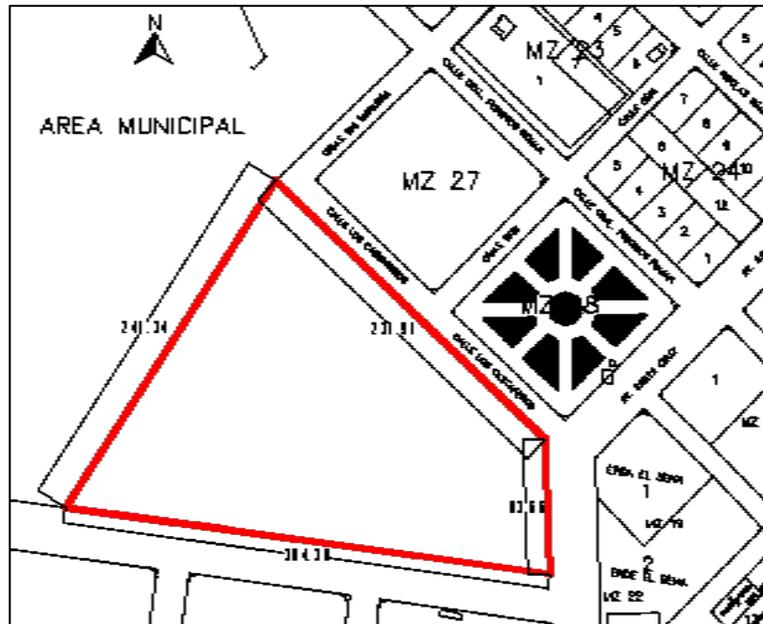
Terreno disponible para emplazamiento de la planta solar Sena
